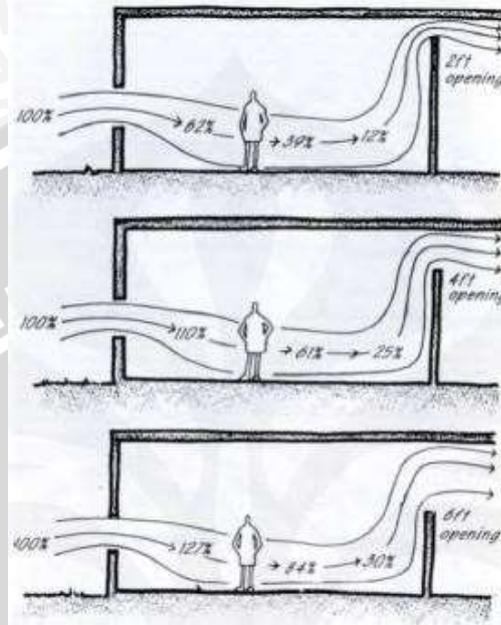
Ruang inlet yang lebih kecil daripada outlet
